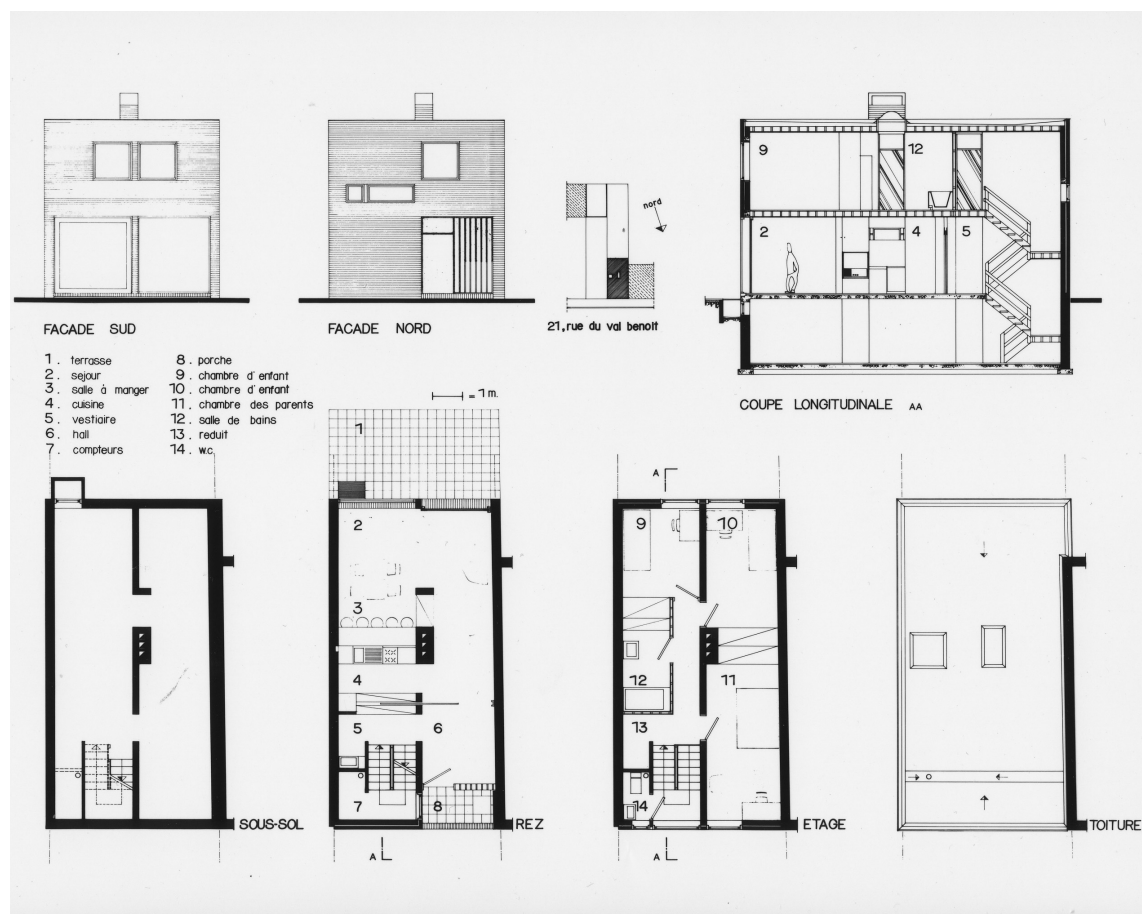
Plans, façades et coupe de la maison "Urbany".
